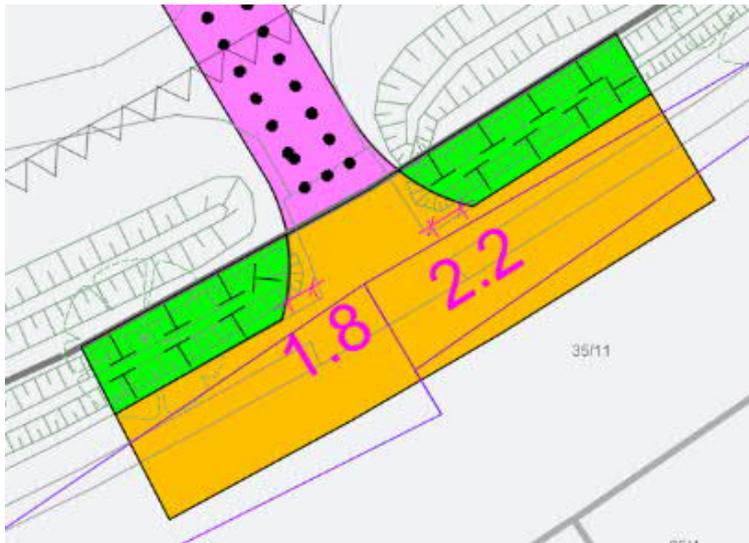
Ausschnitt aus der Planzeichnung / Knickverlust an der Landesstraße
